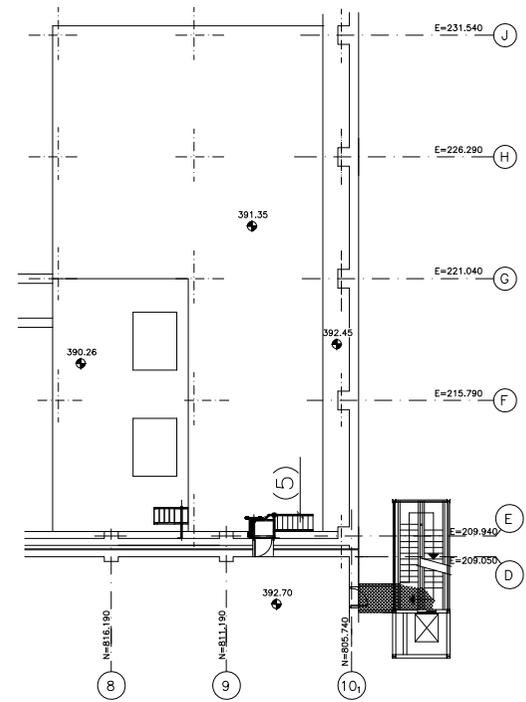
PLANO DE PENETRACIONES ED. AUXILIAR DE ACOND. - PLANTA BAJA
